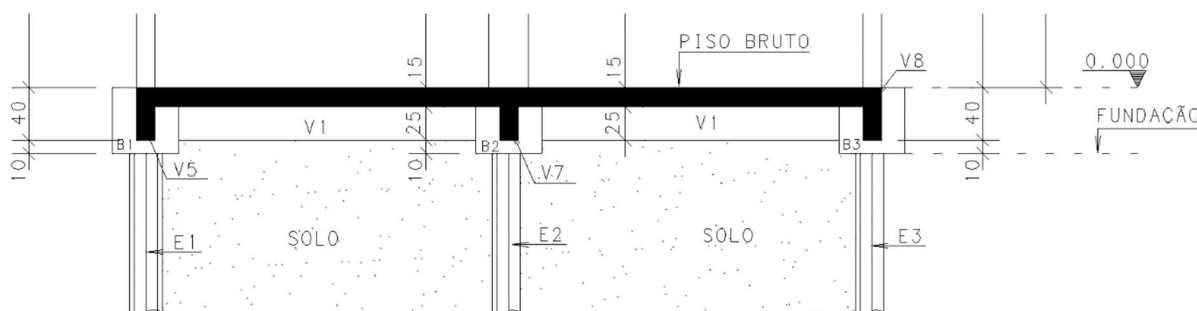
Detalhe em Corte da Fundação (blocos, estacas e vigas).
